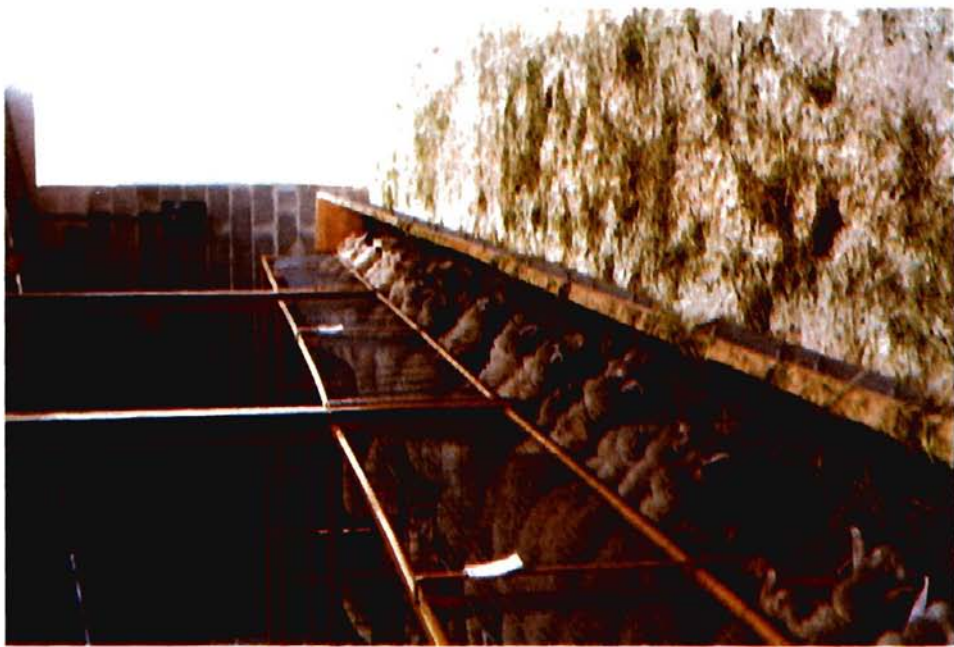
Edificio per ovini da latte o da ingrasso (particolari)
